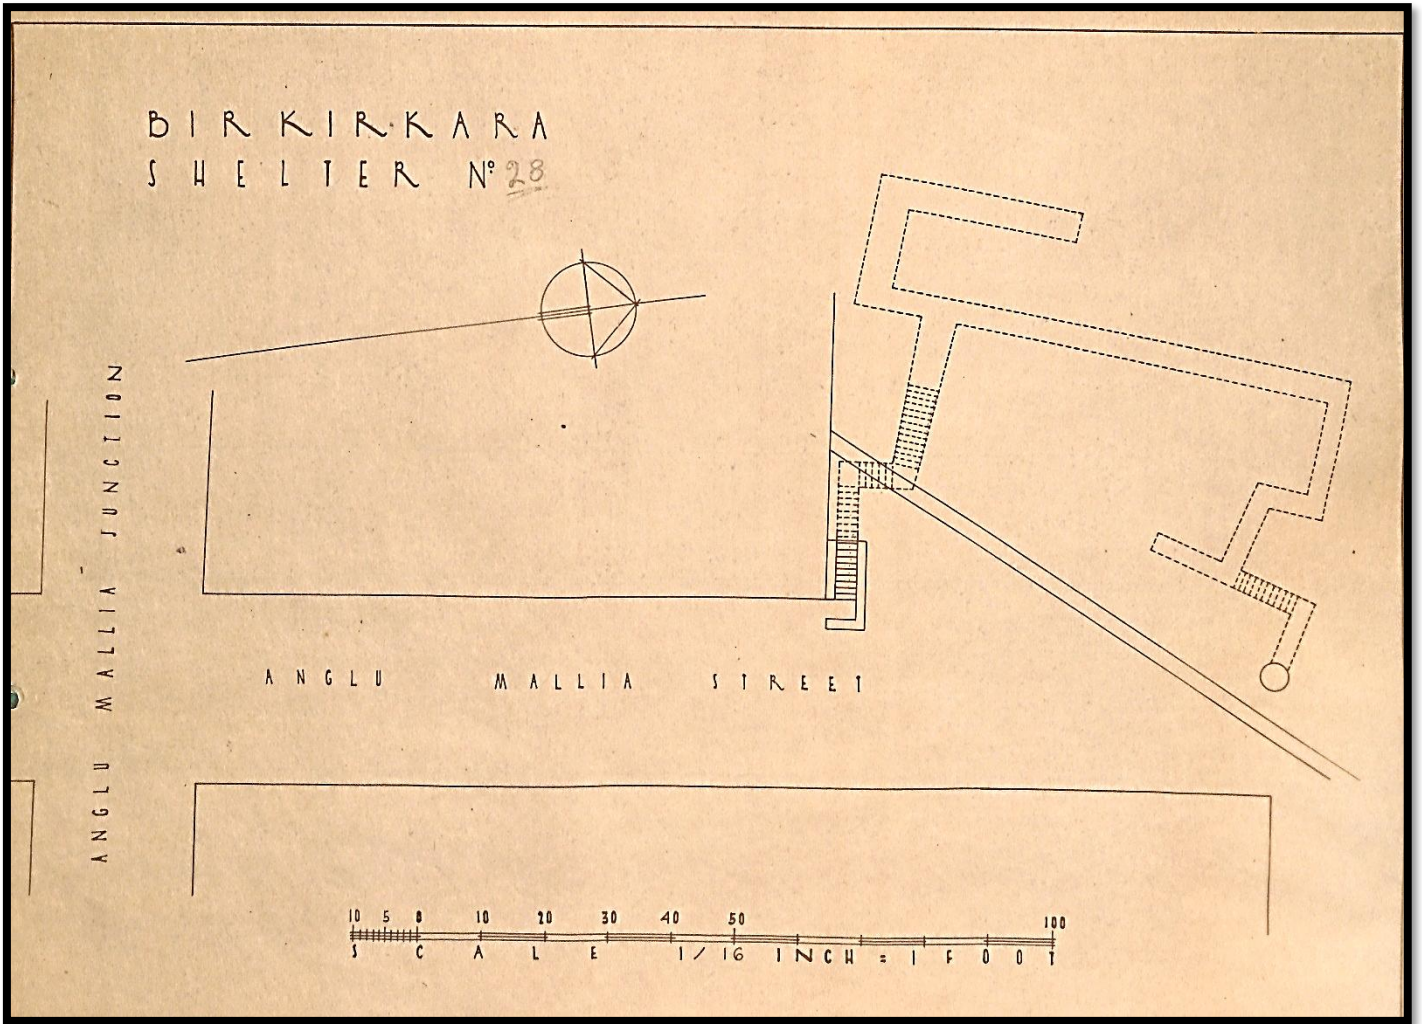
Planta do Abrigo nº 28 "Anglu Mallia Junction – Anglu Mallia Street"
